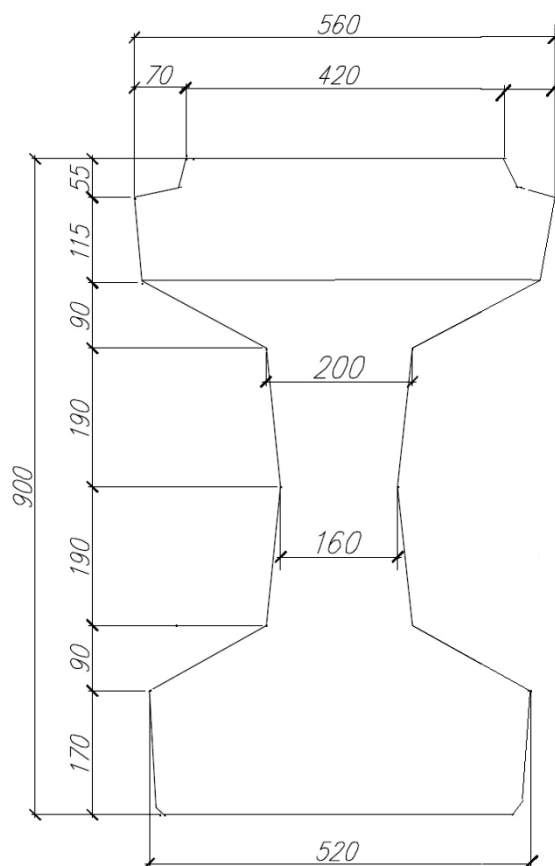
Поперечный разрез балки типа «3 Бет-90»
